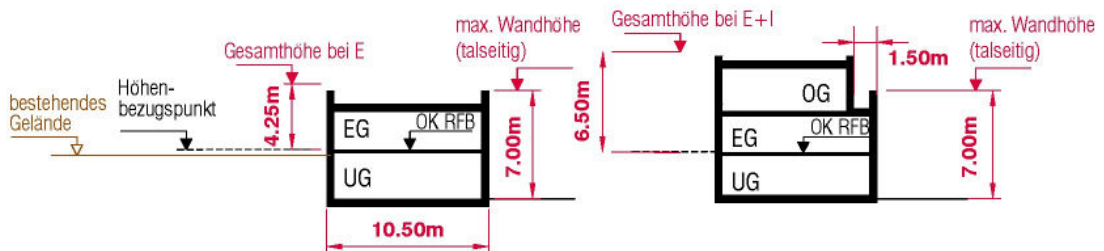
Beispielhafte Gebäudetypen mit Flachdach im WA 2.x
